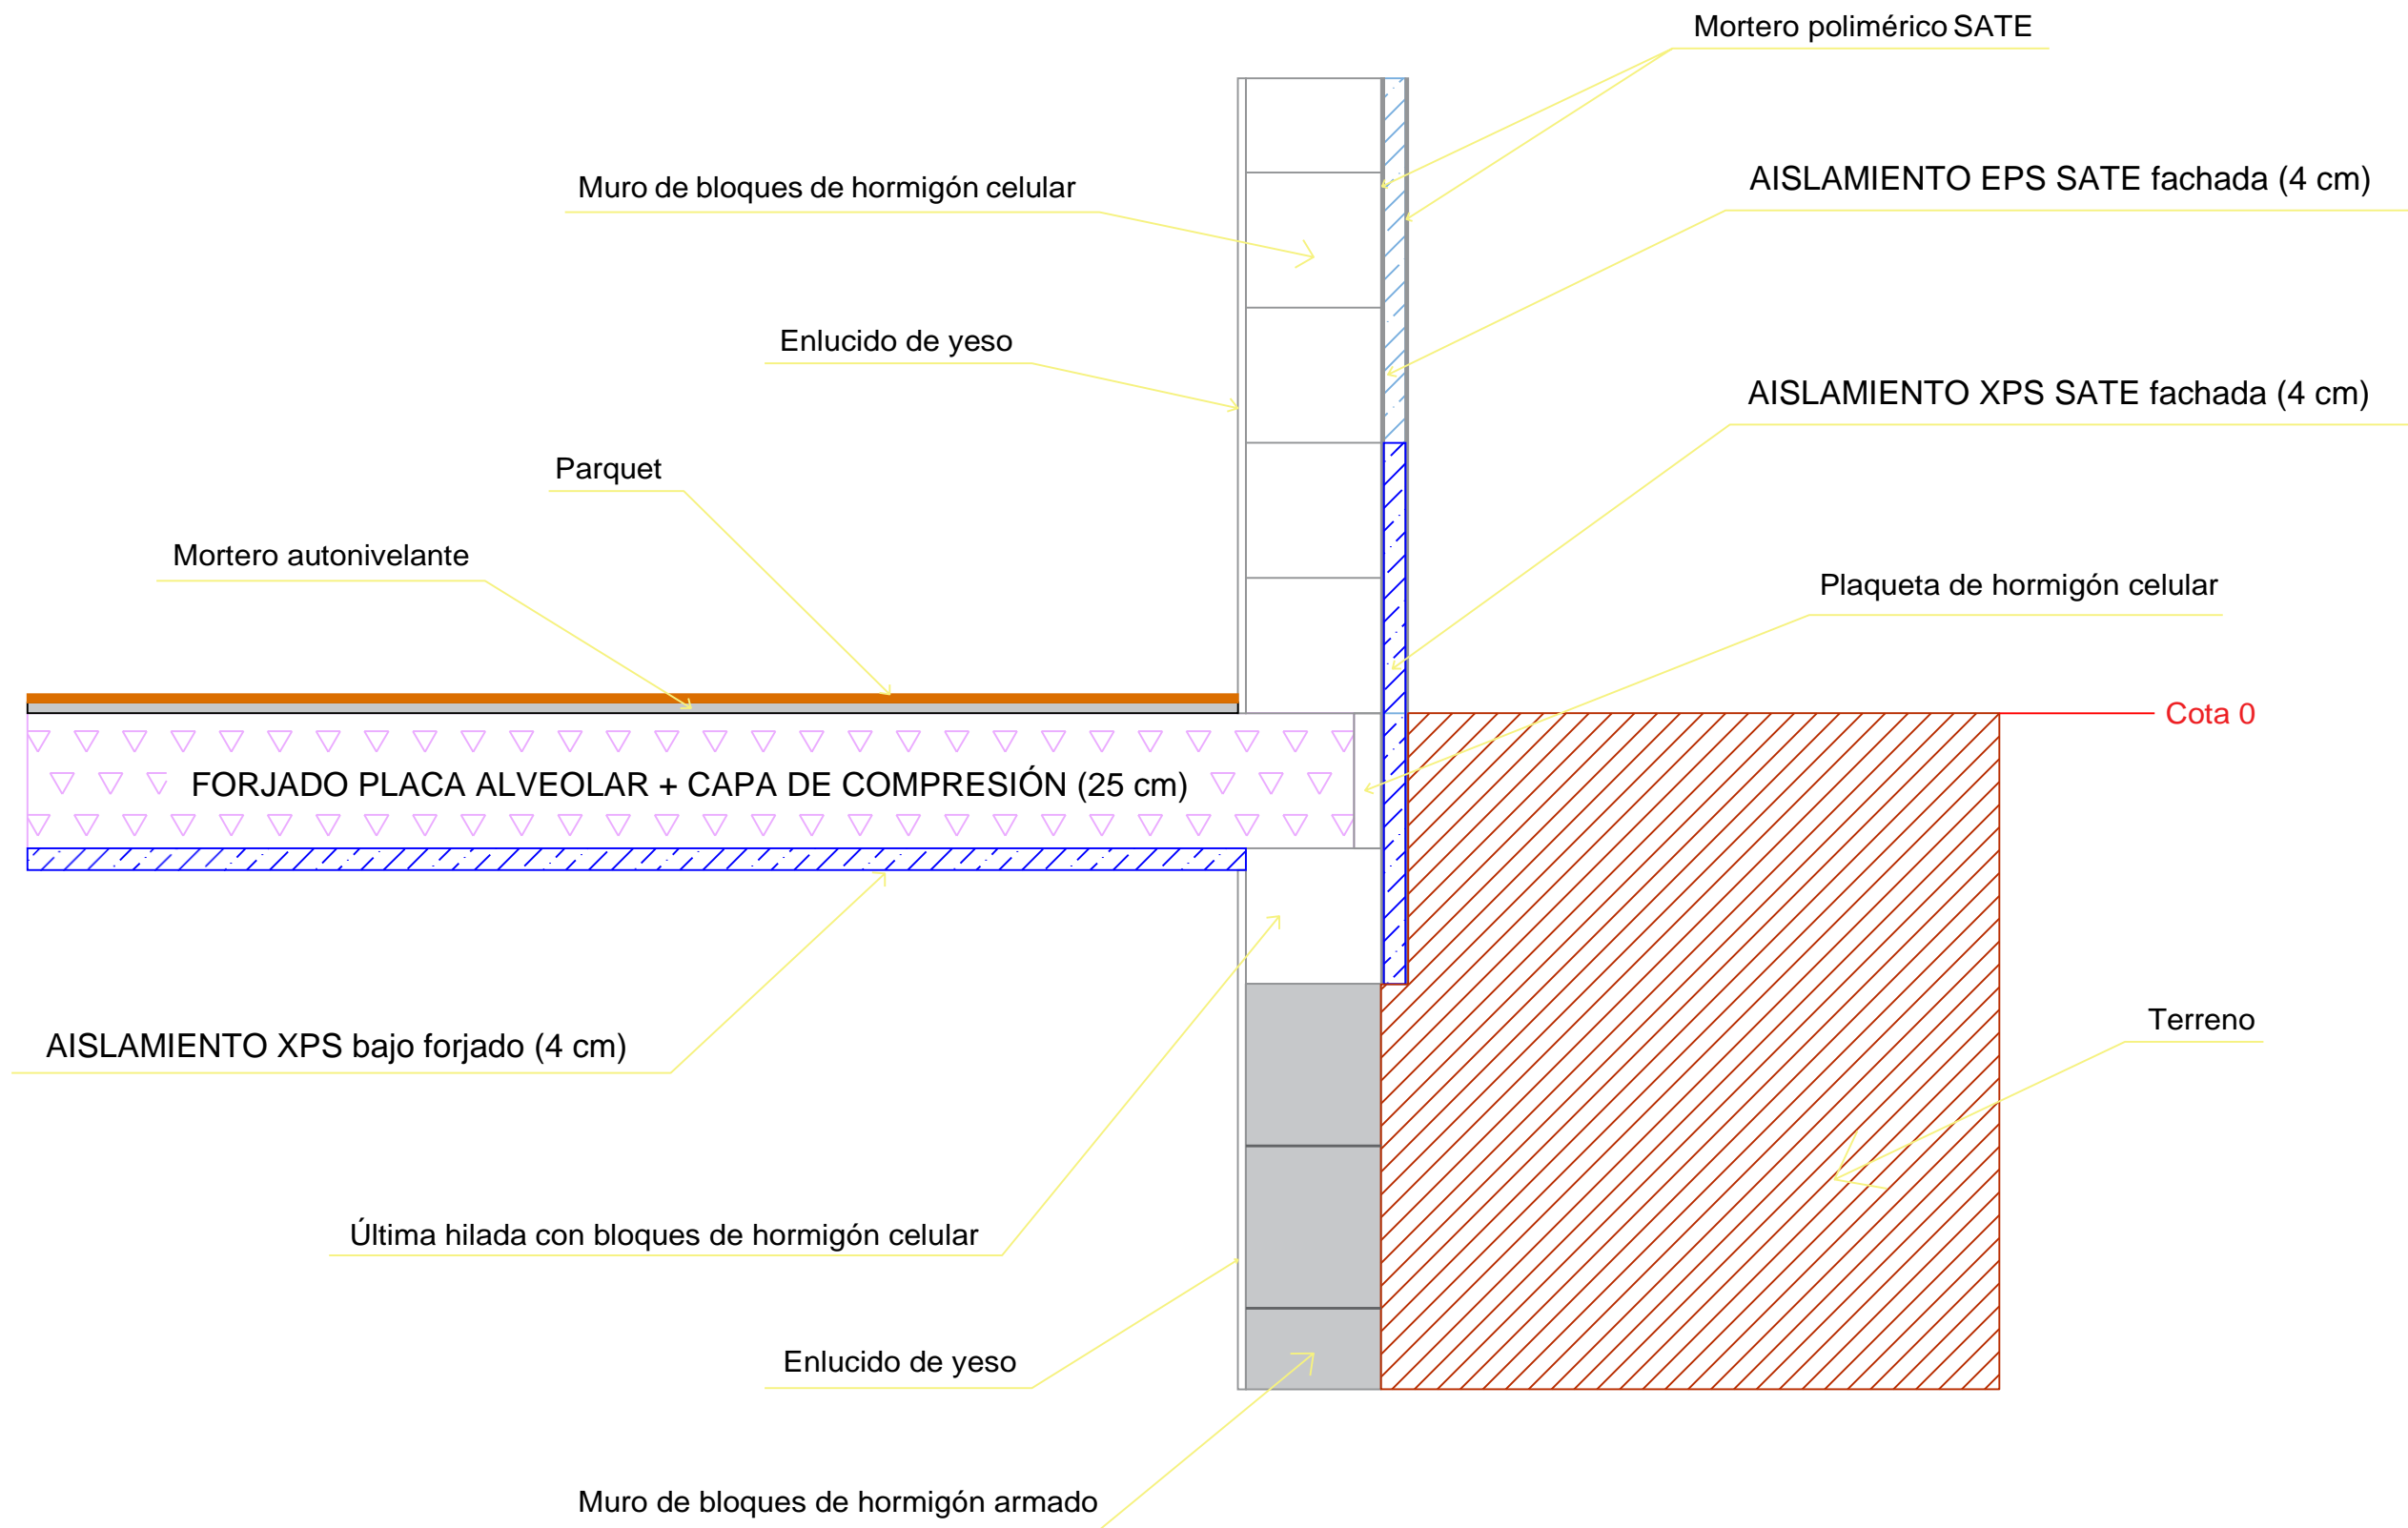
Detalle del encuentro del forjado que separa la planta baja y el sótano con la fachada exterior en contacto con el terreno existente. Fuente: elaboración propia.
